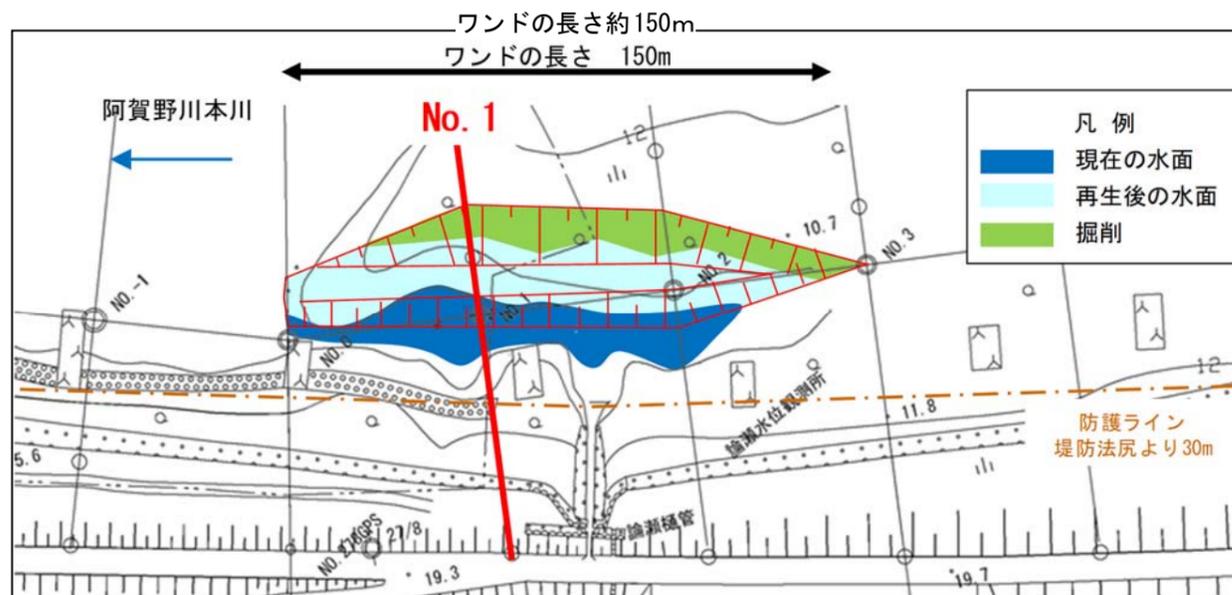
論瀨地区ワンドの計画平面図（イメージ）
